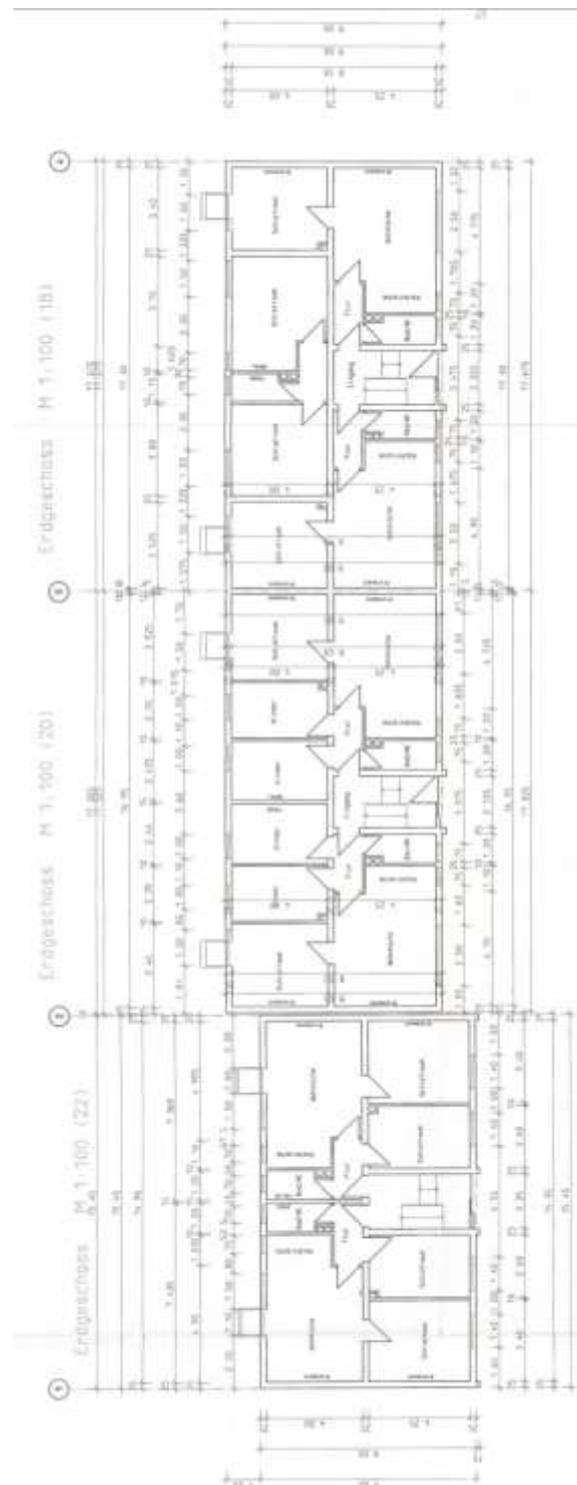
Grundriss Erdgeschoss (EG)
